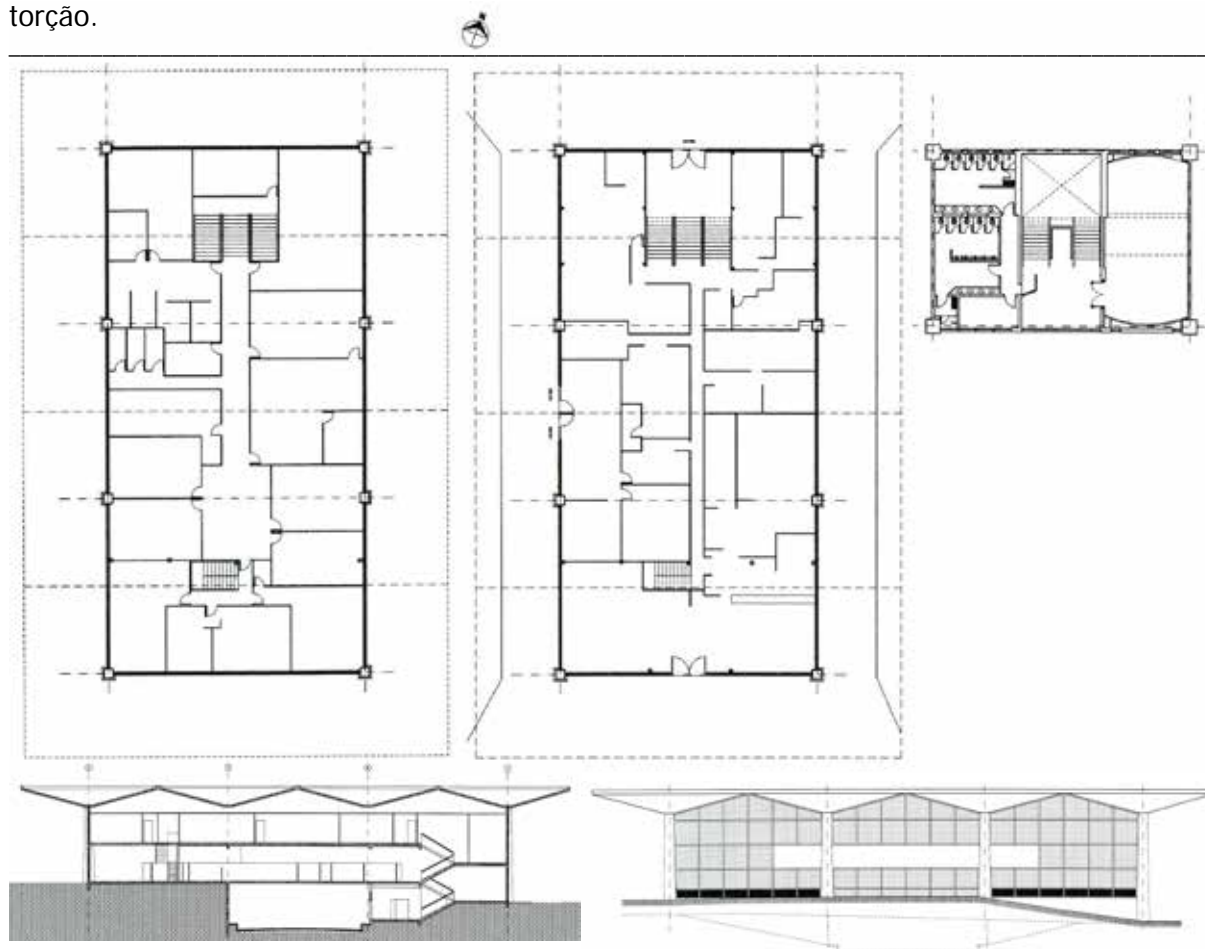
Estação Rodoviária de Curitiba; pavilhão administrativo (URBS): planta pavimento superior;
